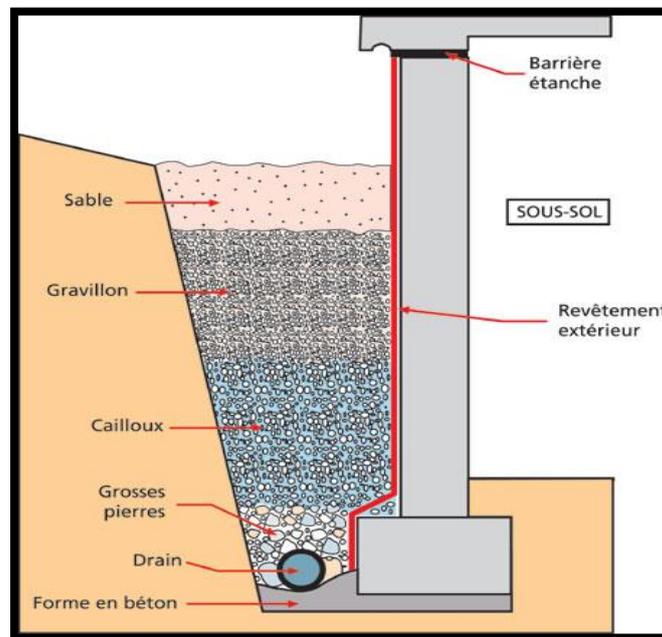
Drainage d'un mur de soutènement<sup>183</sup>
